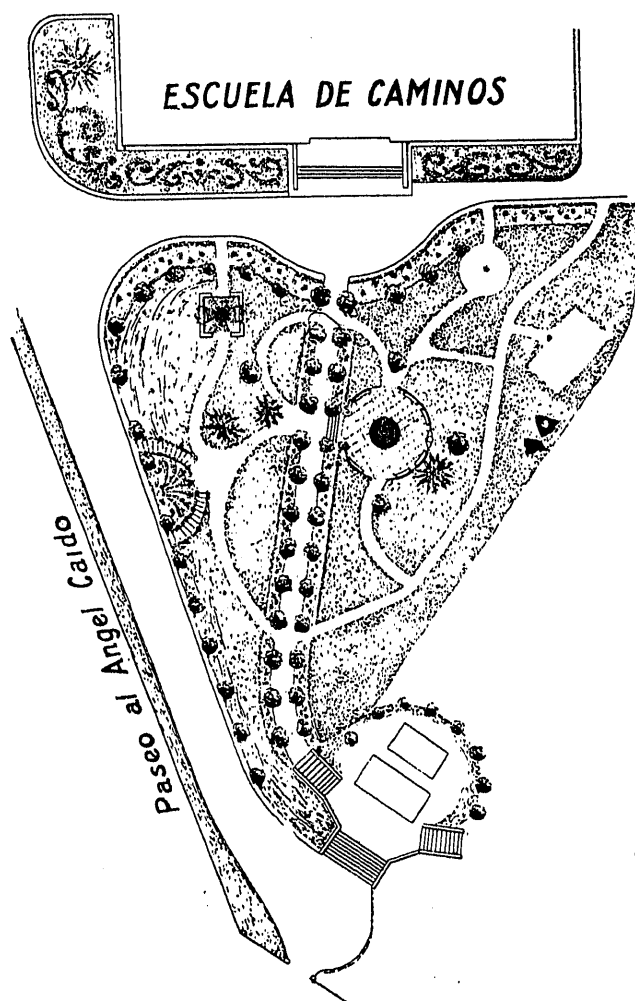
ª Plano del jardín, proyecto de Winthuysen.
